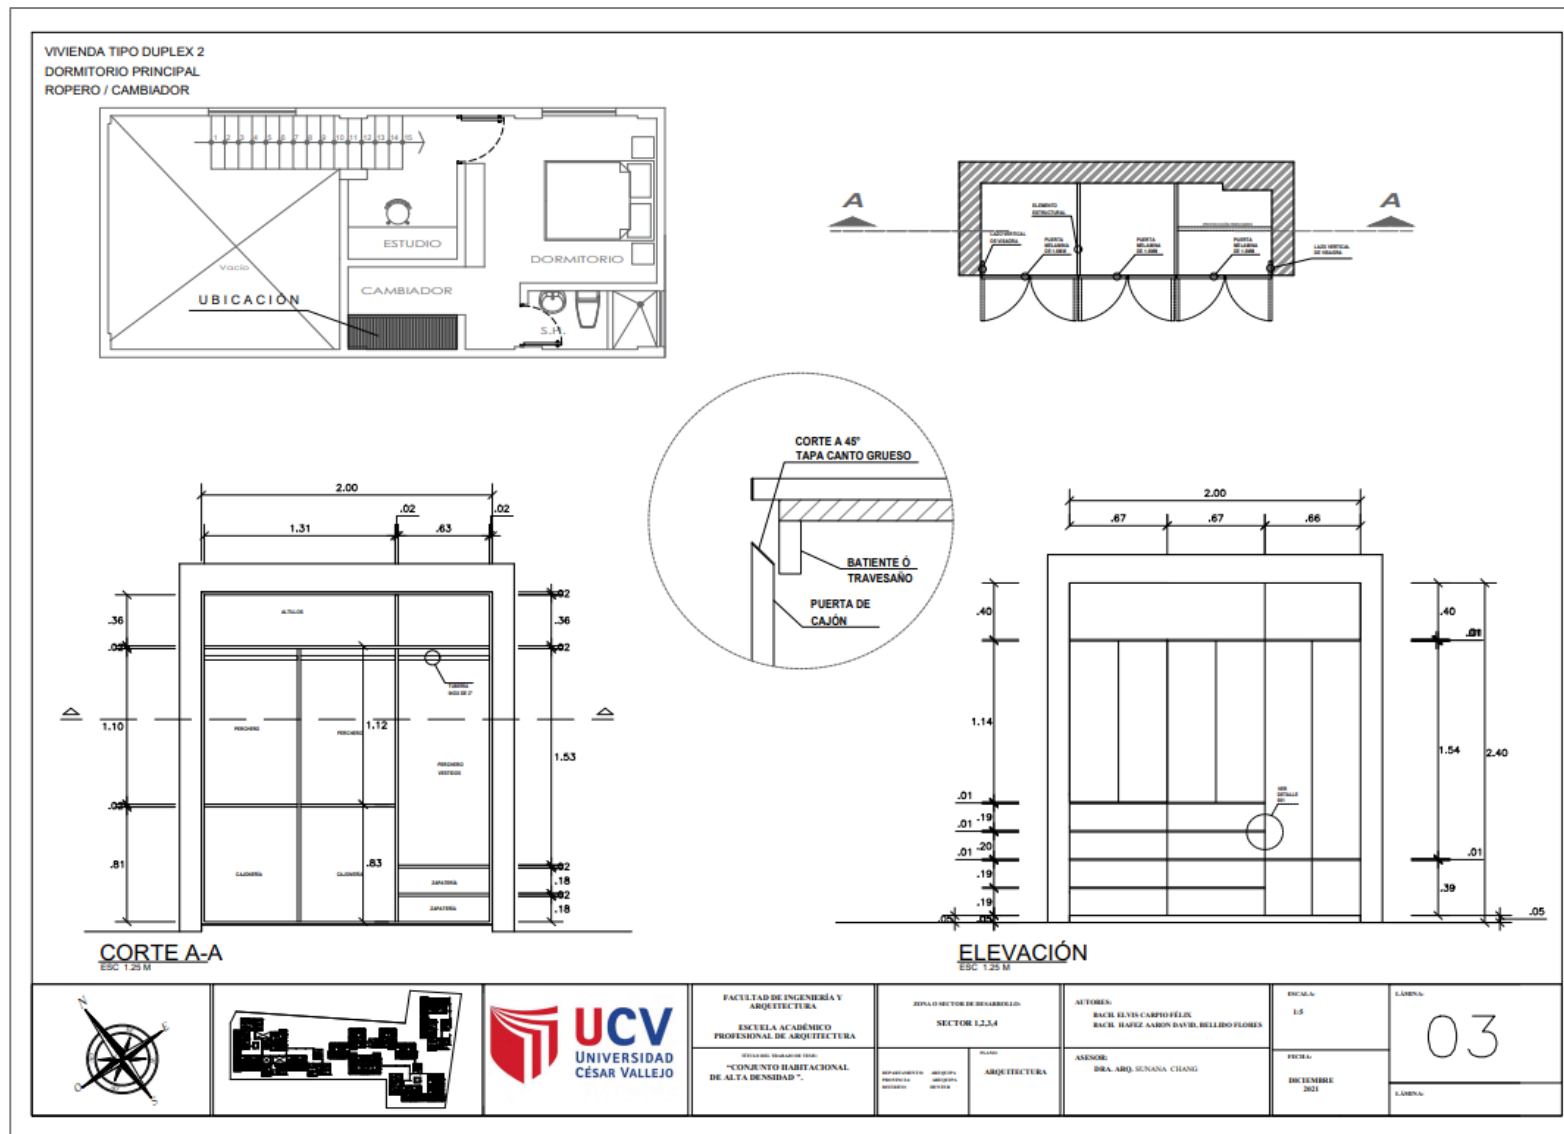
Plano de Detalle Arquitectónico – Armario Vivienda Tipo Dúplex 2 - 03
